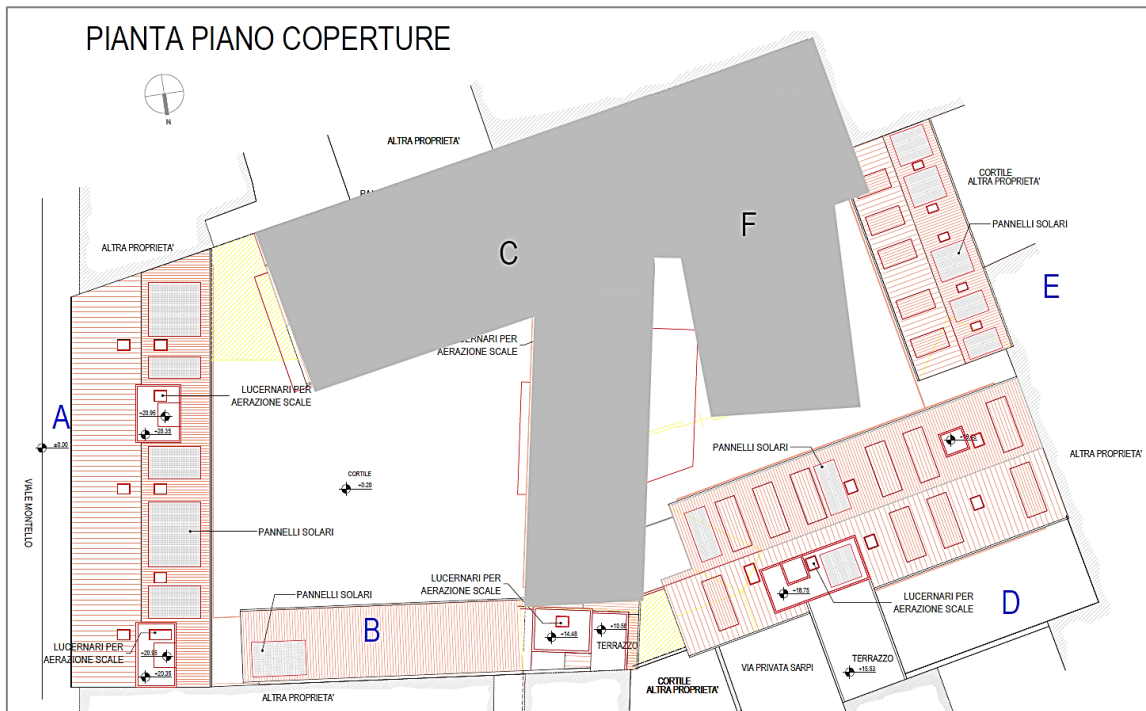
Pianta coperture dei blocchi A, B, D, E con indicazione dei pannelli solari.
